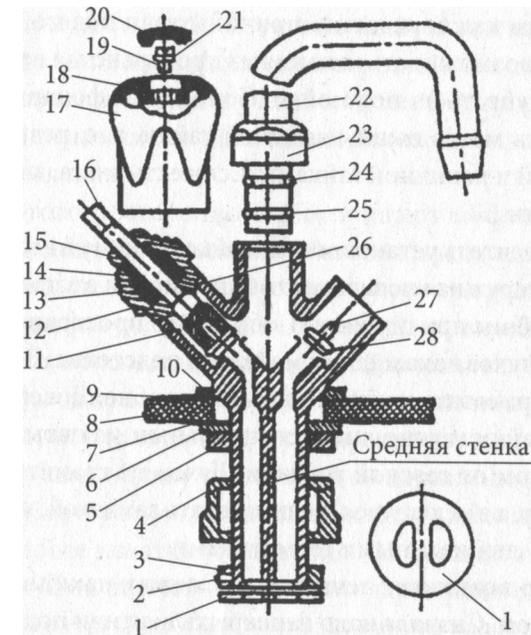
Смеситель центральный настольный с верхней камерой смешивания типа «елочка» с накладной гайкой и тройником: 1 — прокладка смесителя; 2 — стопор; 3 — гайка четырехгранная установочная; 4 — накладная гайка; 5 — поджимная гайка; 6, 10 — металлические шайбы; 7, 9 — резиновые прокладки; 8 — полочка мойки или умывальника; 11 — корпус смесителя; 12 — корпус головки крана; 13 — сальник; 14 — кольцо; 15 — втулка сальника; 16 — шток; 17 — маховик; 18 — шайба маховика (латунь); 19 — винт; 20 — указатель; 21 — металлическая шайба; 22 — излив; 23 — накладная гайка; 24 — разжимное пластмассовое кольцо; 25 — резиновое кольцо; 26 — уплотнение; 27 — клапан; 28 — прокладка
